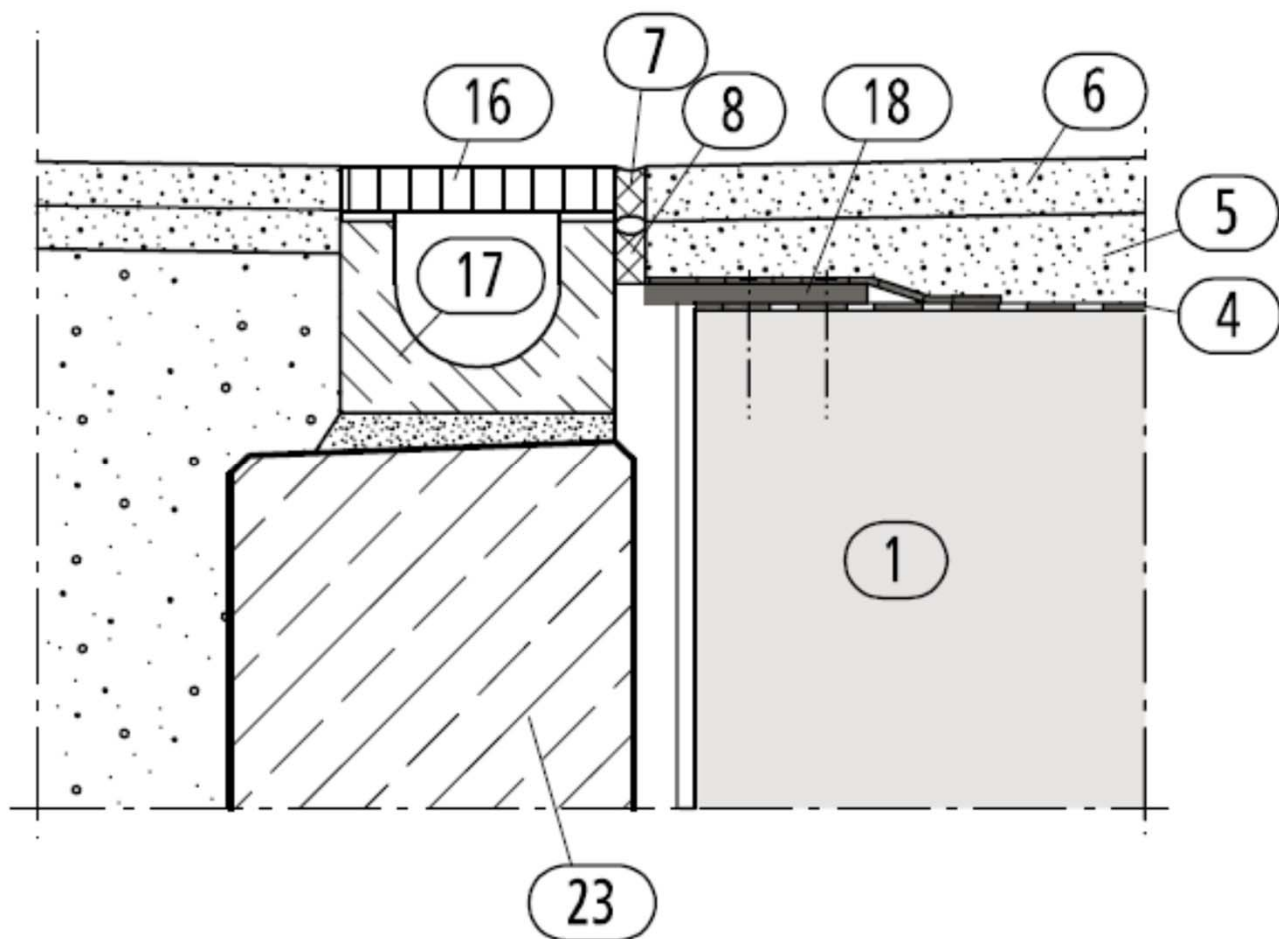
Detailschnitt Bohlenrost mit Blehabdichtung; Geh- und Radwegbrücke
